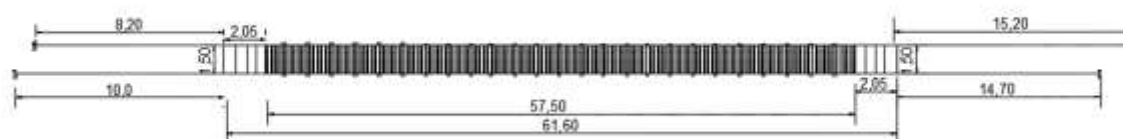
Planta da ponte de Santo Aleixo de Além Tâmega
